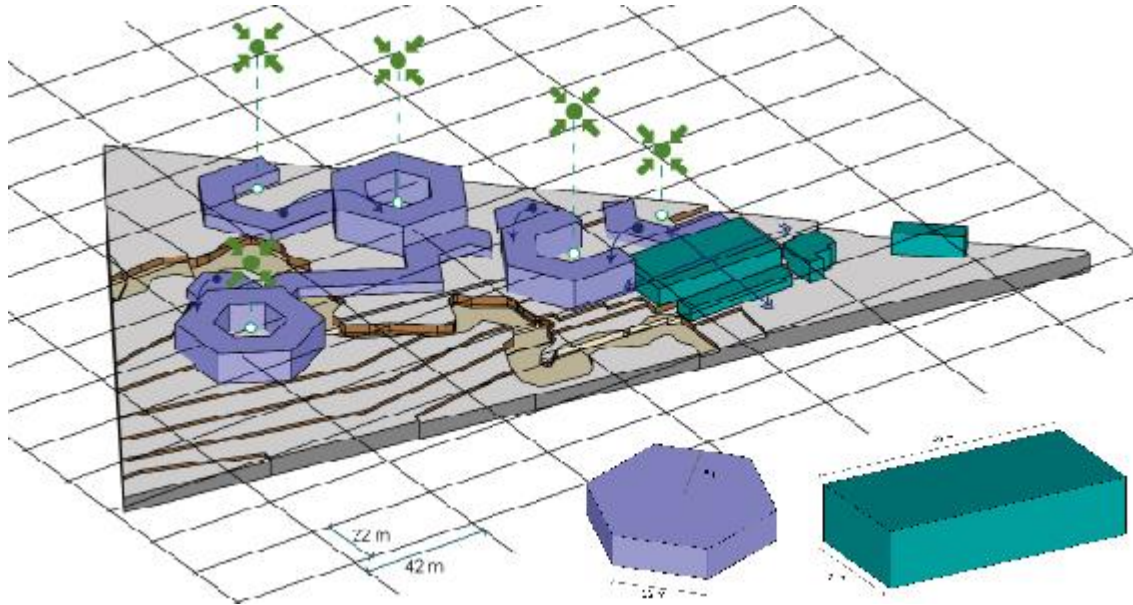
Maqueta, propuesta de implantación 2.
